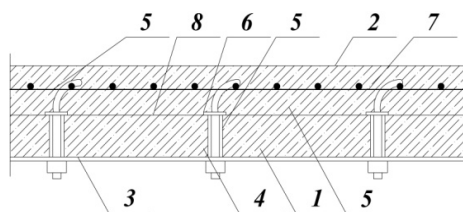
Устройство железобетонного наращивания сверху плиты при недостаточном сцеплении нового бетона со старым [1]:
